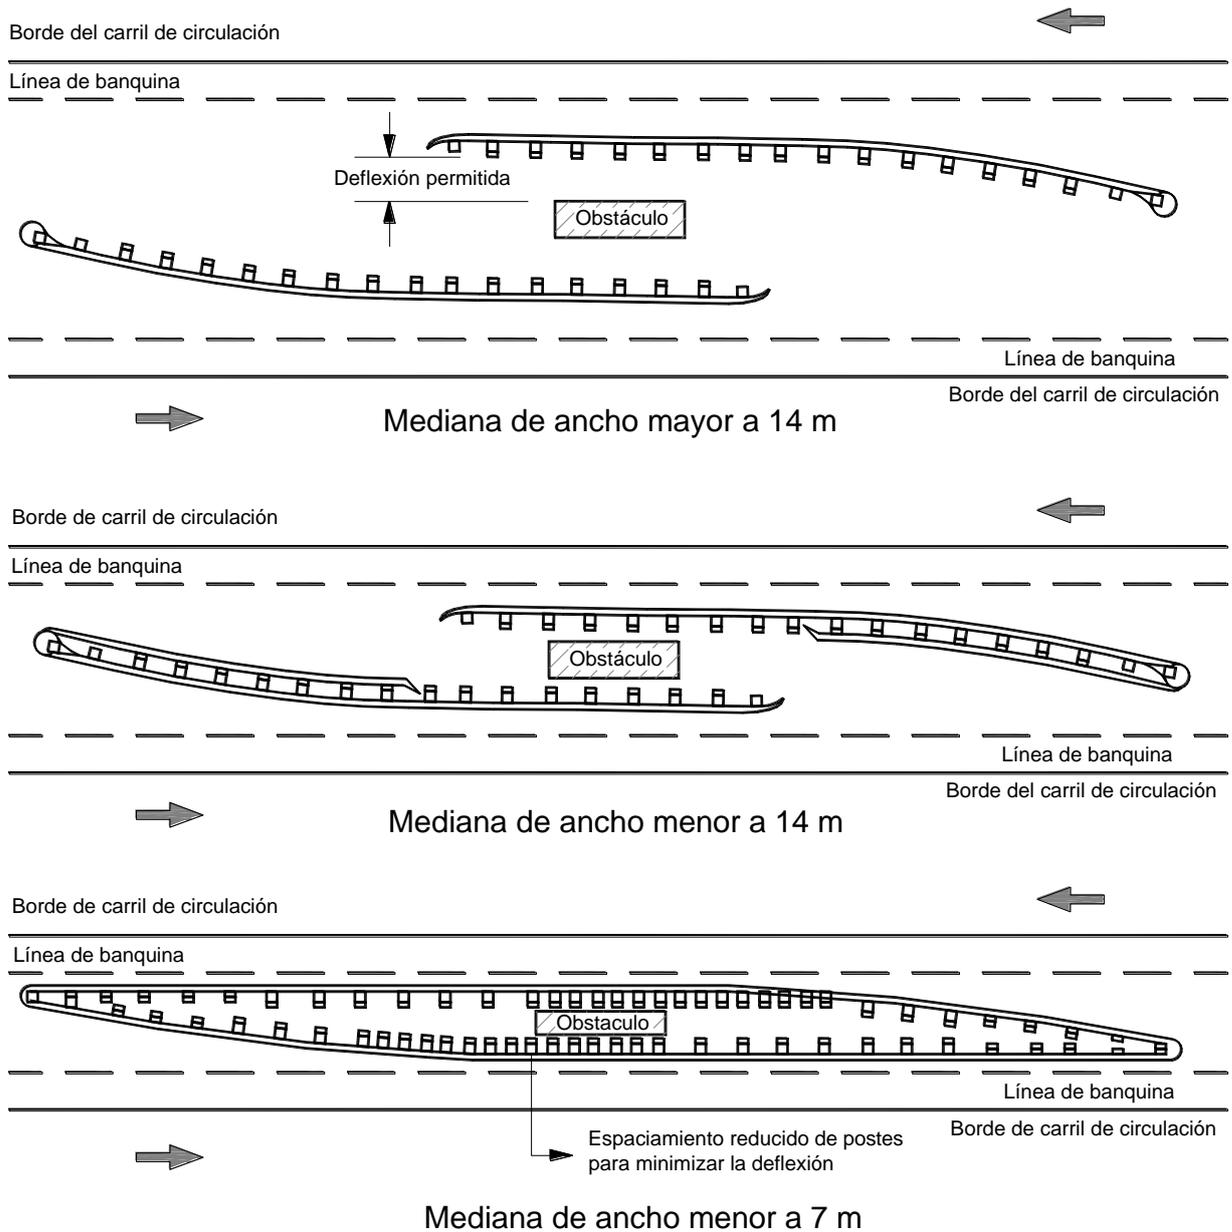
TRATAMIENTO DE OBSTÁCULOS CON BARRERA DE VIGA DE ACERO EN SEPARADOR CENTRAL
